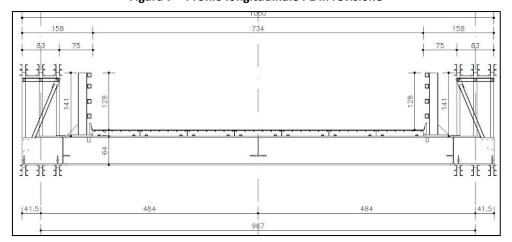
Sezione tipo ponte Bailey PE in revisione
